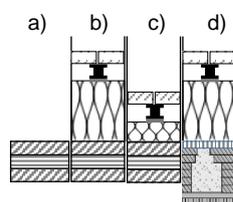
Flachdächer aus Massivholz-Kastenelementen, EPS Aufdachdämmung, Dachabdichtung und Betonplatten im Kiesbett:
